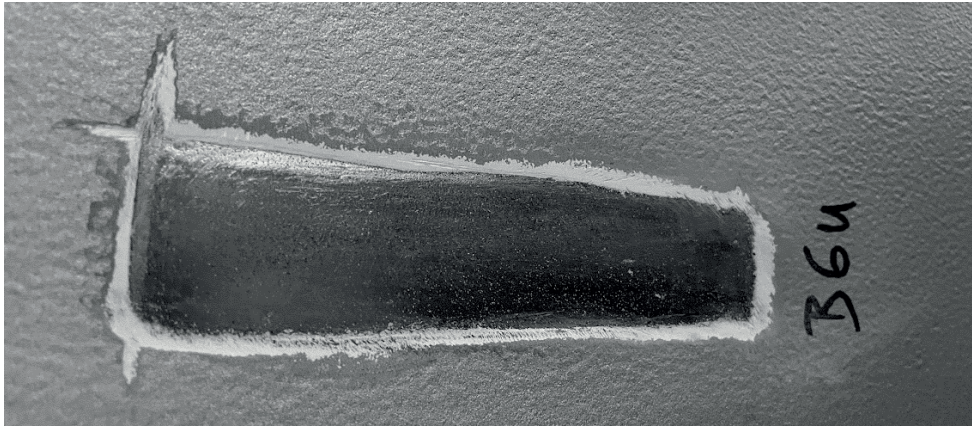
Installationsstelle mit entfernter Korrosionsschutzbeschichtung
